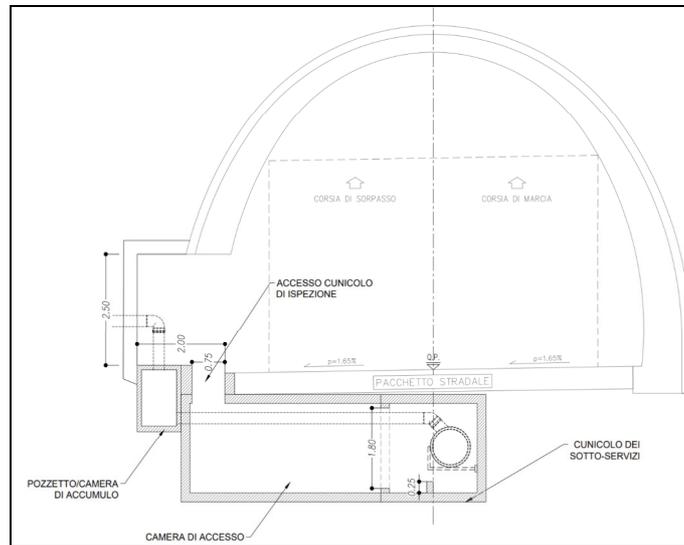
Rappresentazione del sistema idrico di progetto (sezione trasversale)
